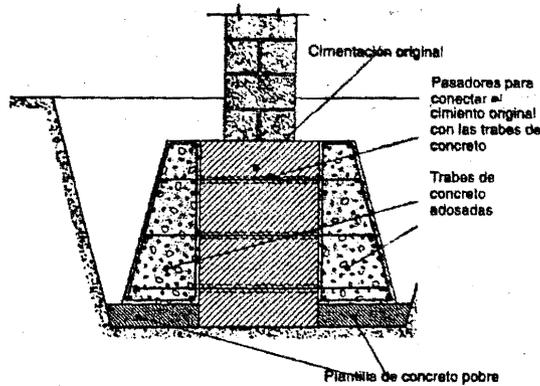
Cimentación de mampostería envuelta en contratrabes de concreto.
